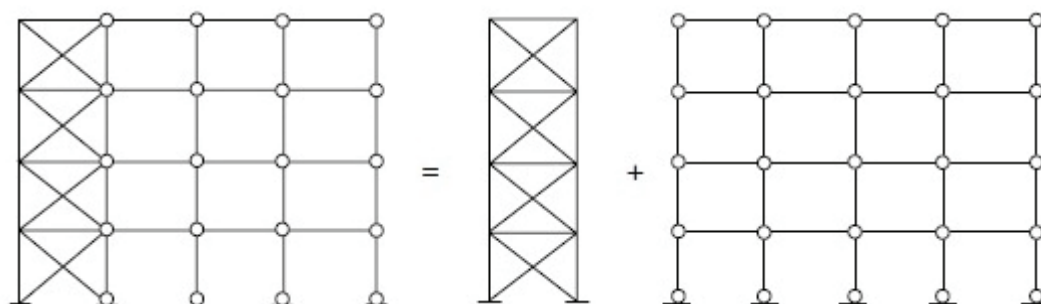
Divisão do pórtico com ligações simples em duas subestruturas [30].
